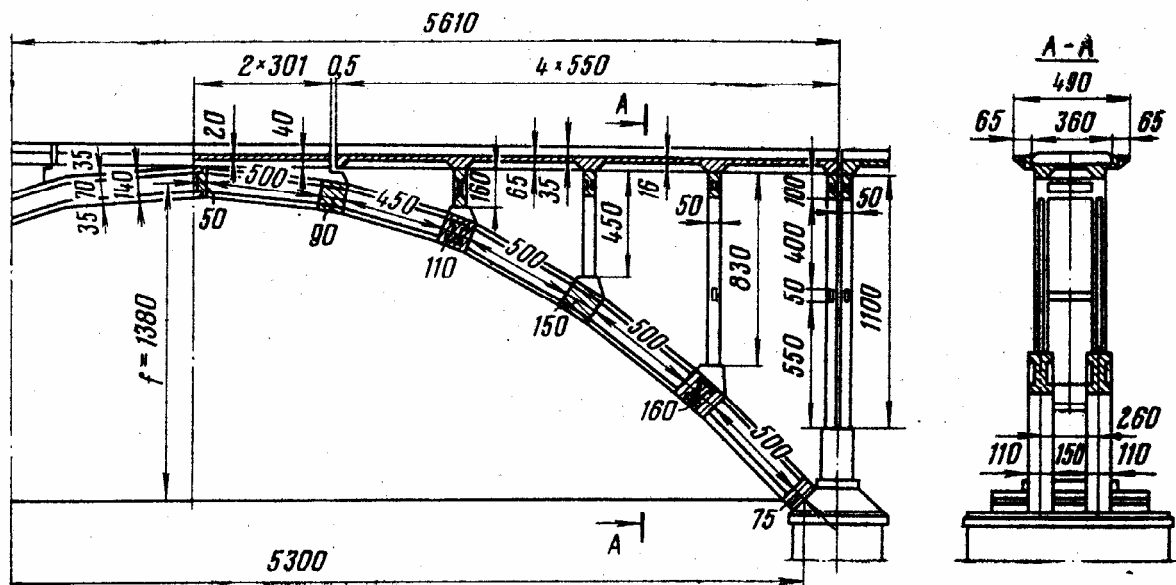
Арочное пролетное строение из железобетона с ездой поверху
